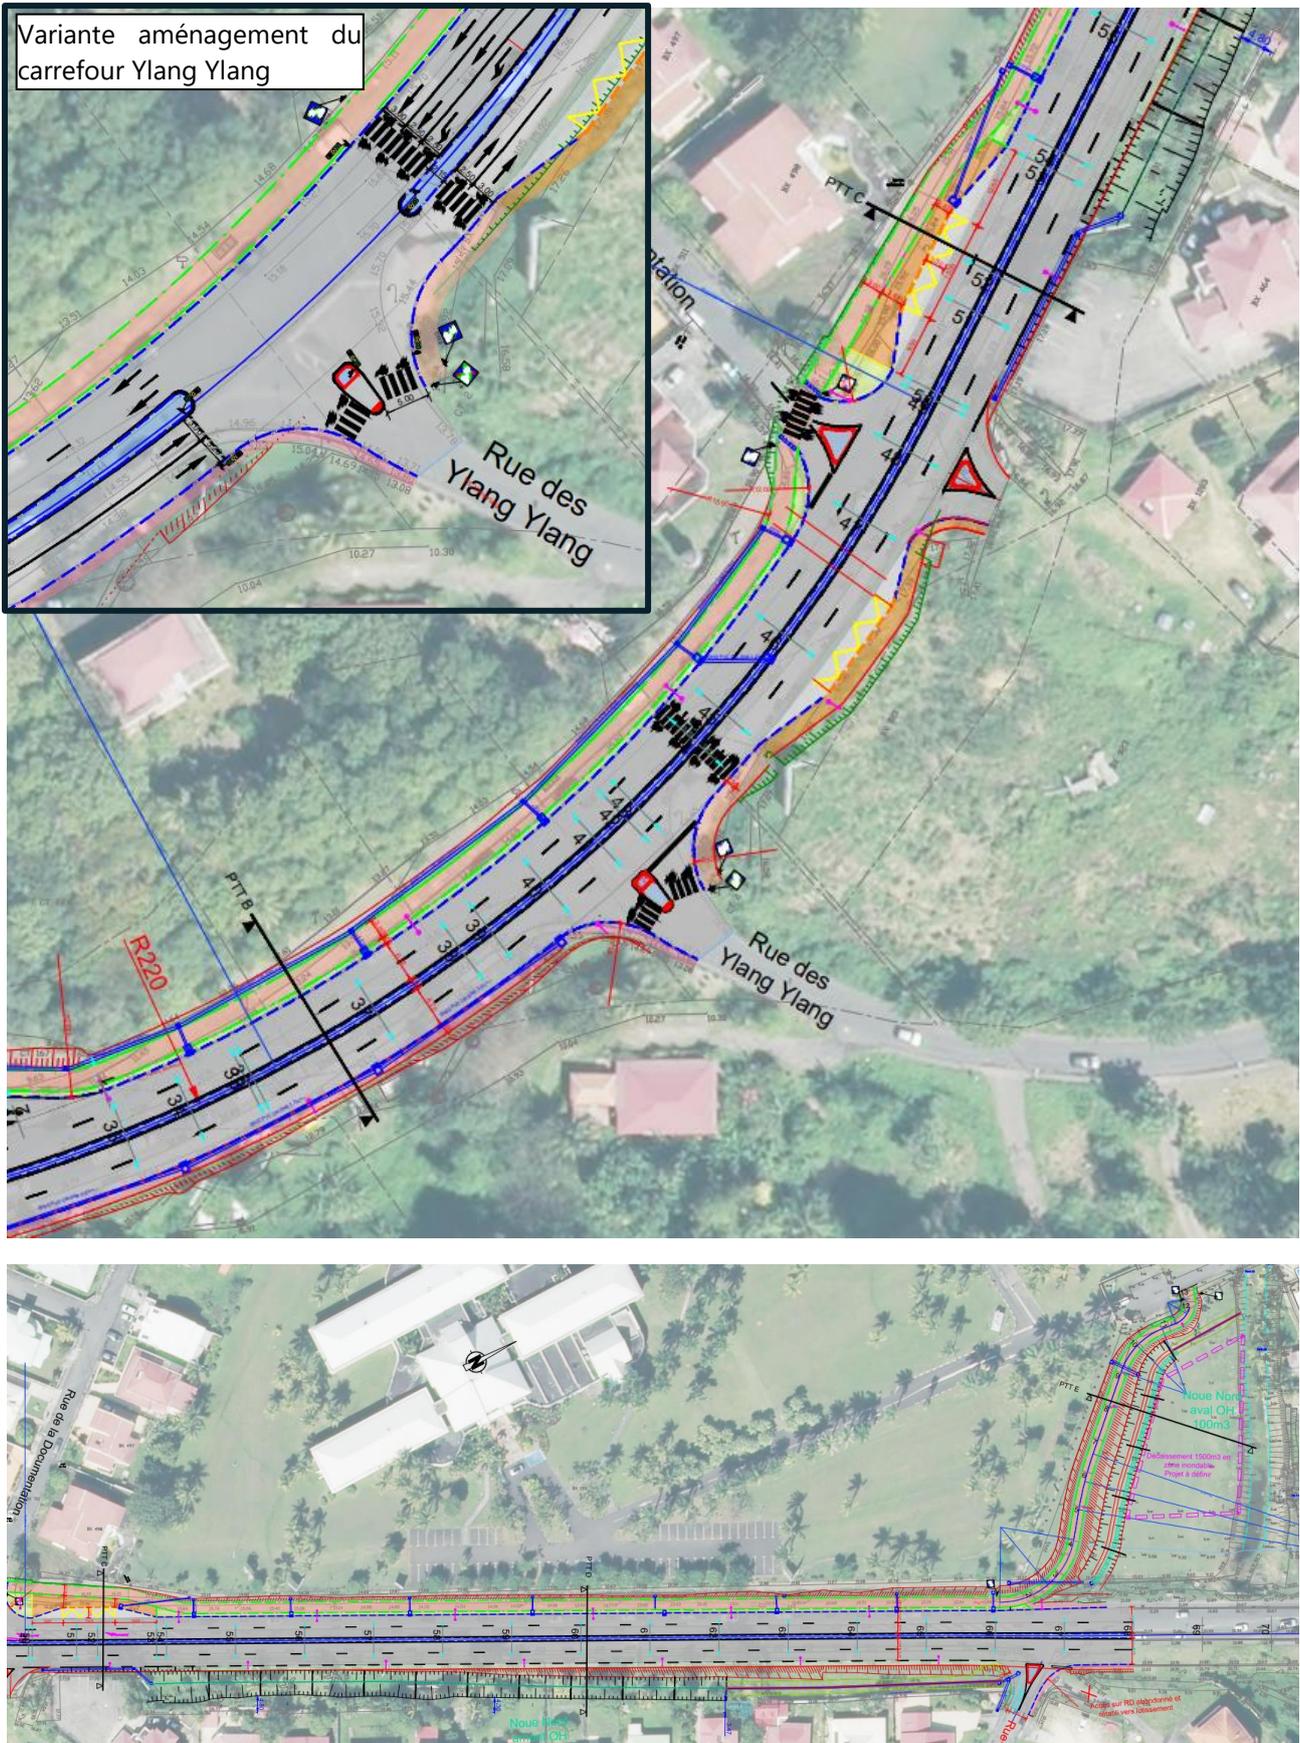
Extraits de plan du projet 2/2 – (Source : Plan AVP, EGIS 12/2022)
